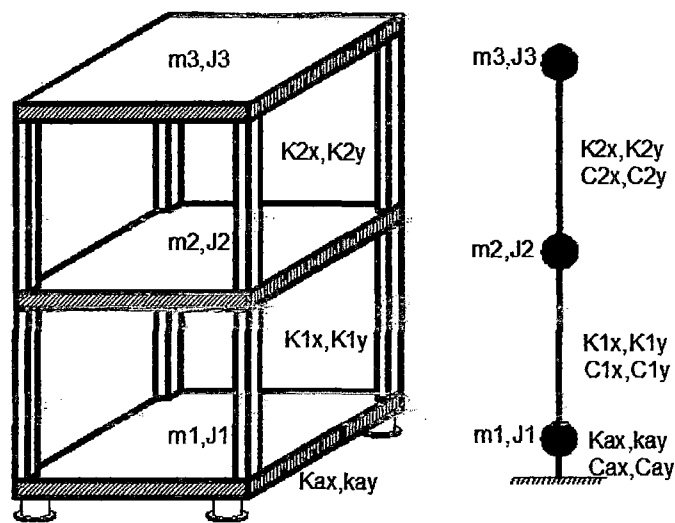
Modelamiento de un sistema aporticado espacial con aisladores.
